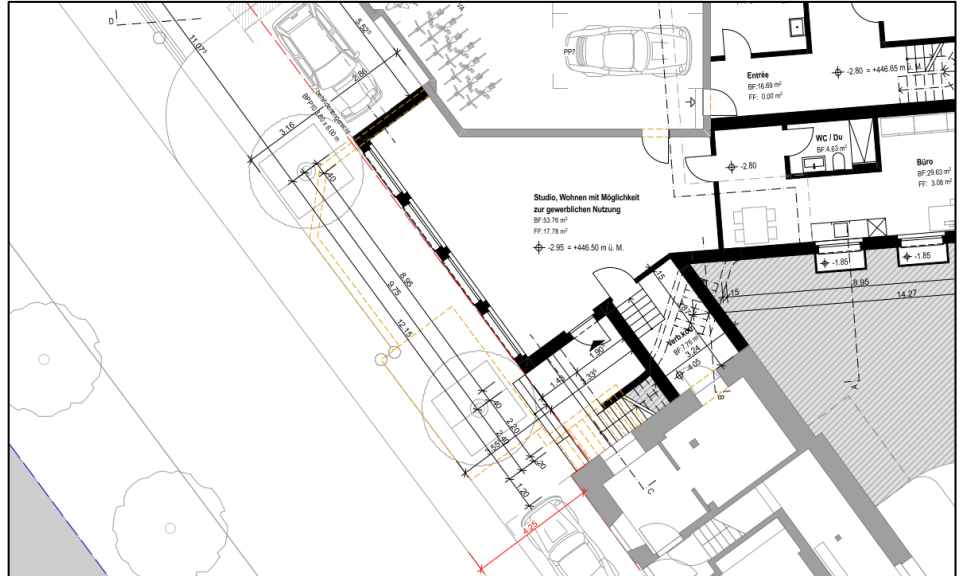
Ausschnitt Grundriss Untergeschoss, Richtprojekt hegglin cozza architekten vom 26.03.2024
